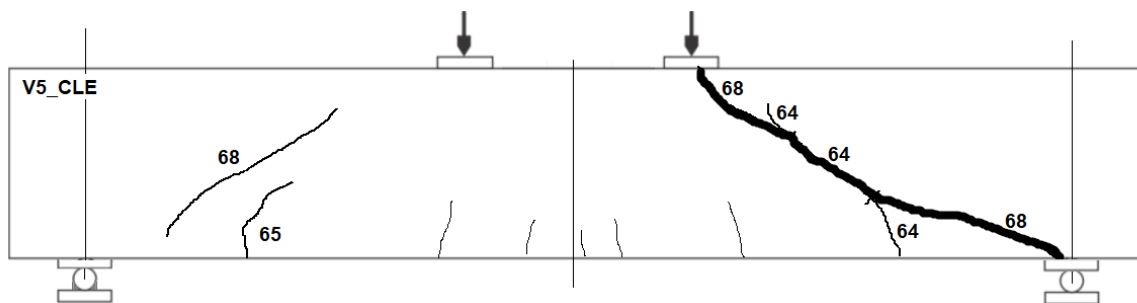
Esquema de fissuração da Viga 5_CLE.
